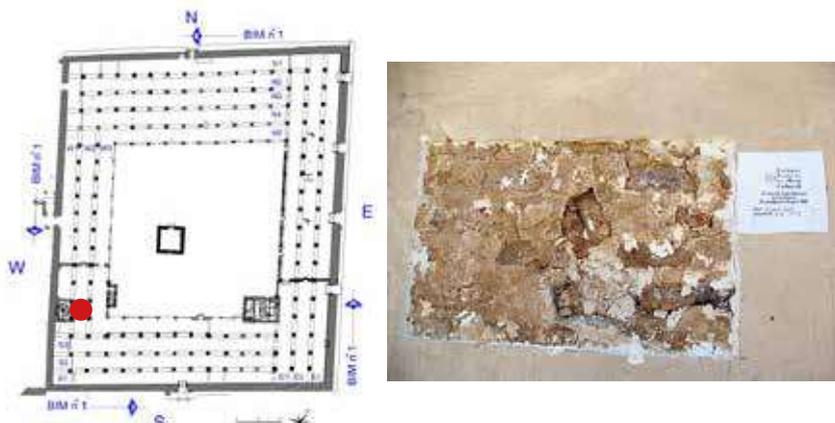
Minareto Ovest, parete Est, campione nr. MWEW0602
